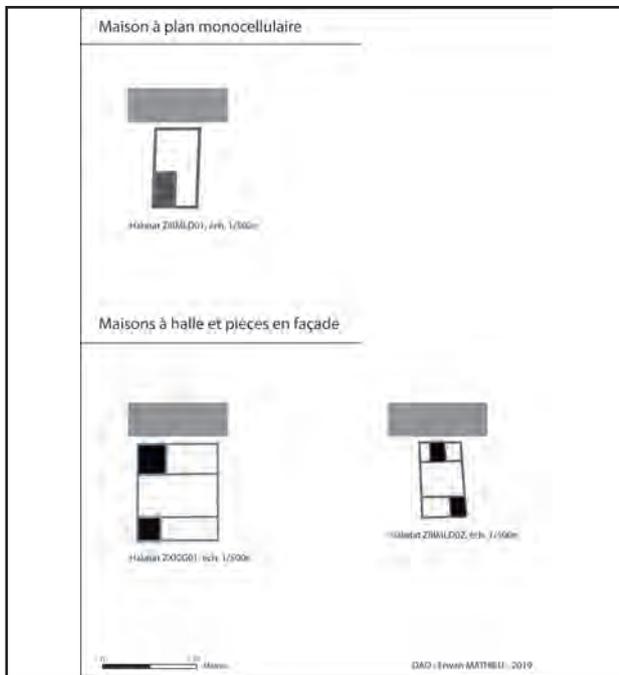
Habitats de Grand rattachables au type 1 (maisons à halle et pièces en façade et maison à plan monocellulaire)
